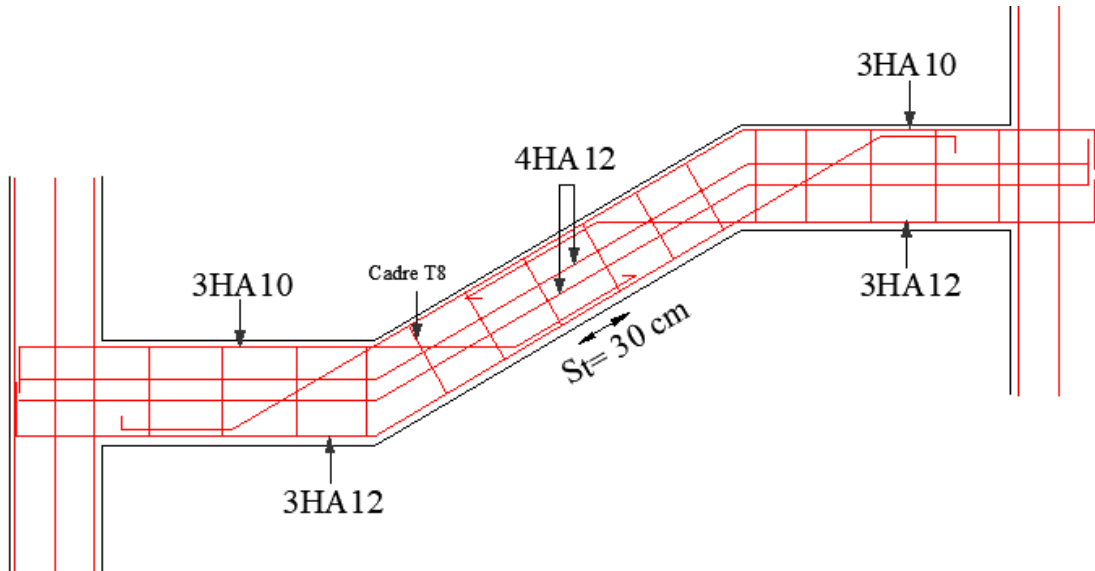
Ferrailage de la poutre brisée (escalier 2)
